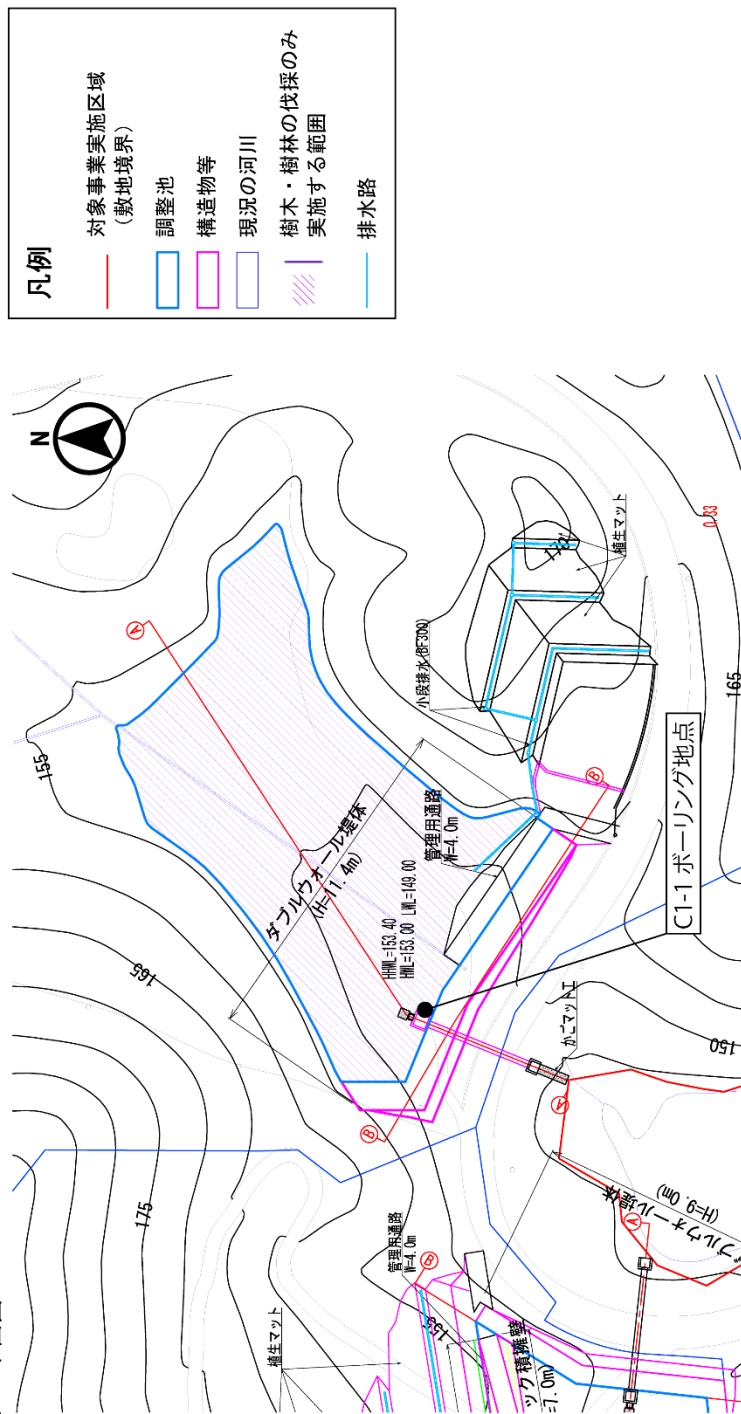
(10) 調整池の平面図・断面図 (B7)
